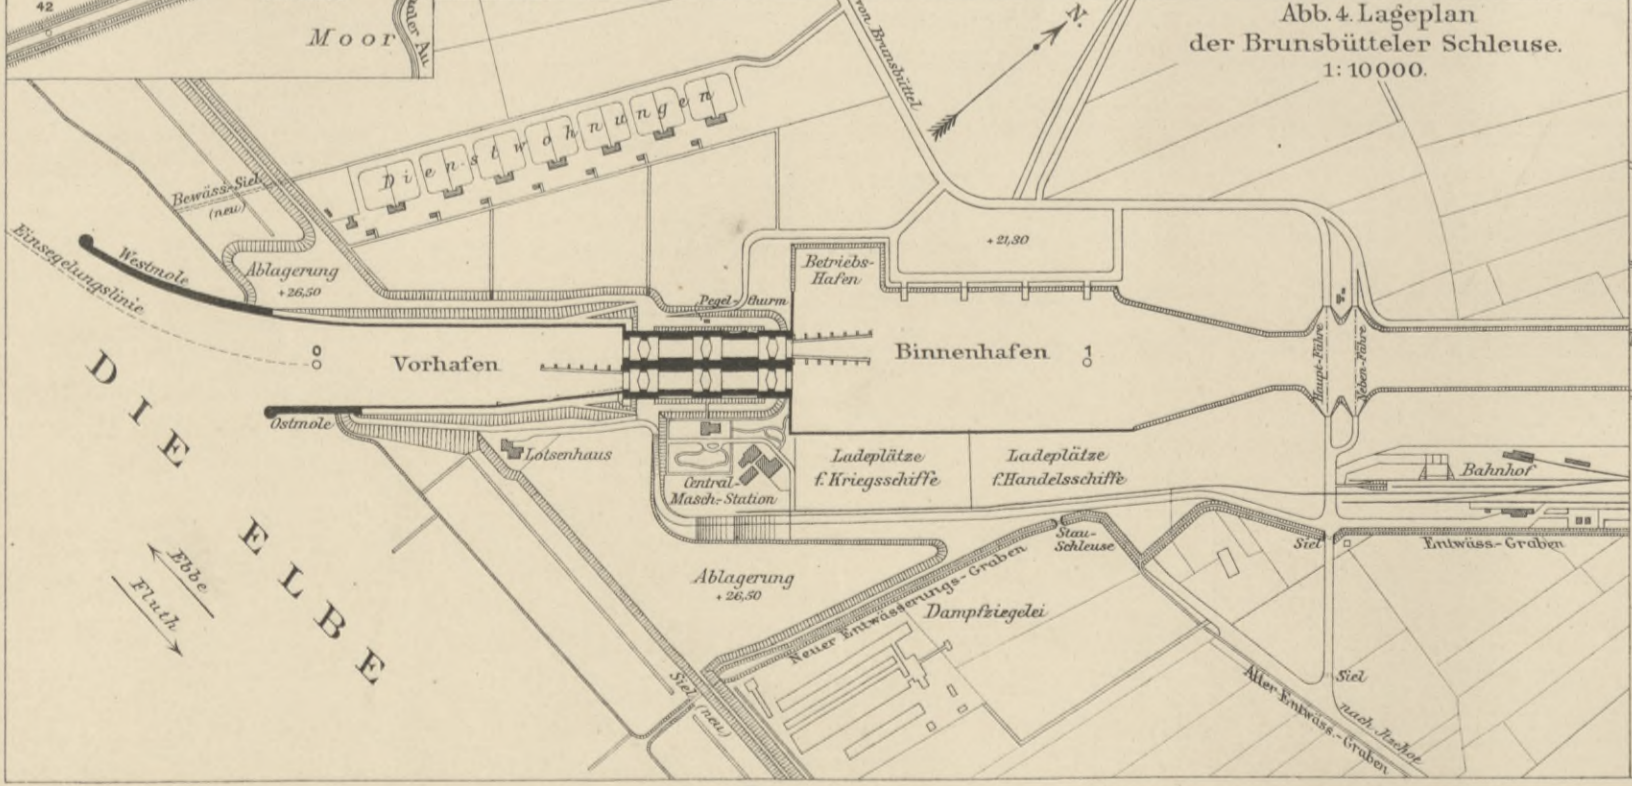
Lageplan der Brunsbütteler Schleuse. 1:10 000.
